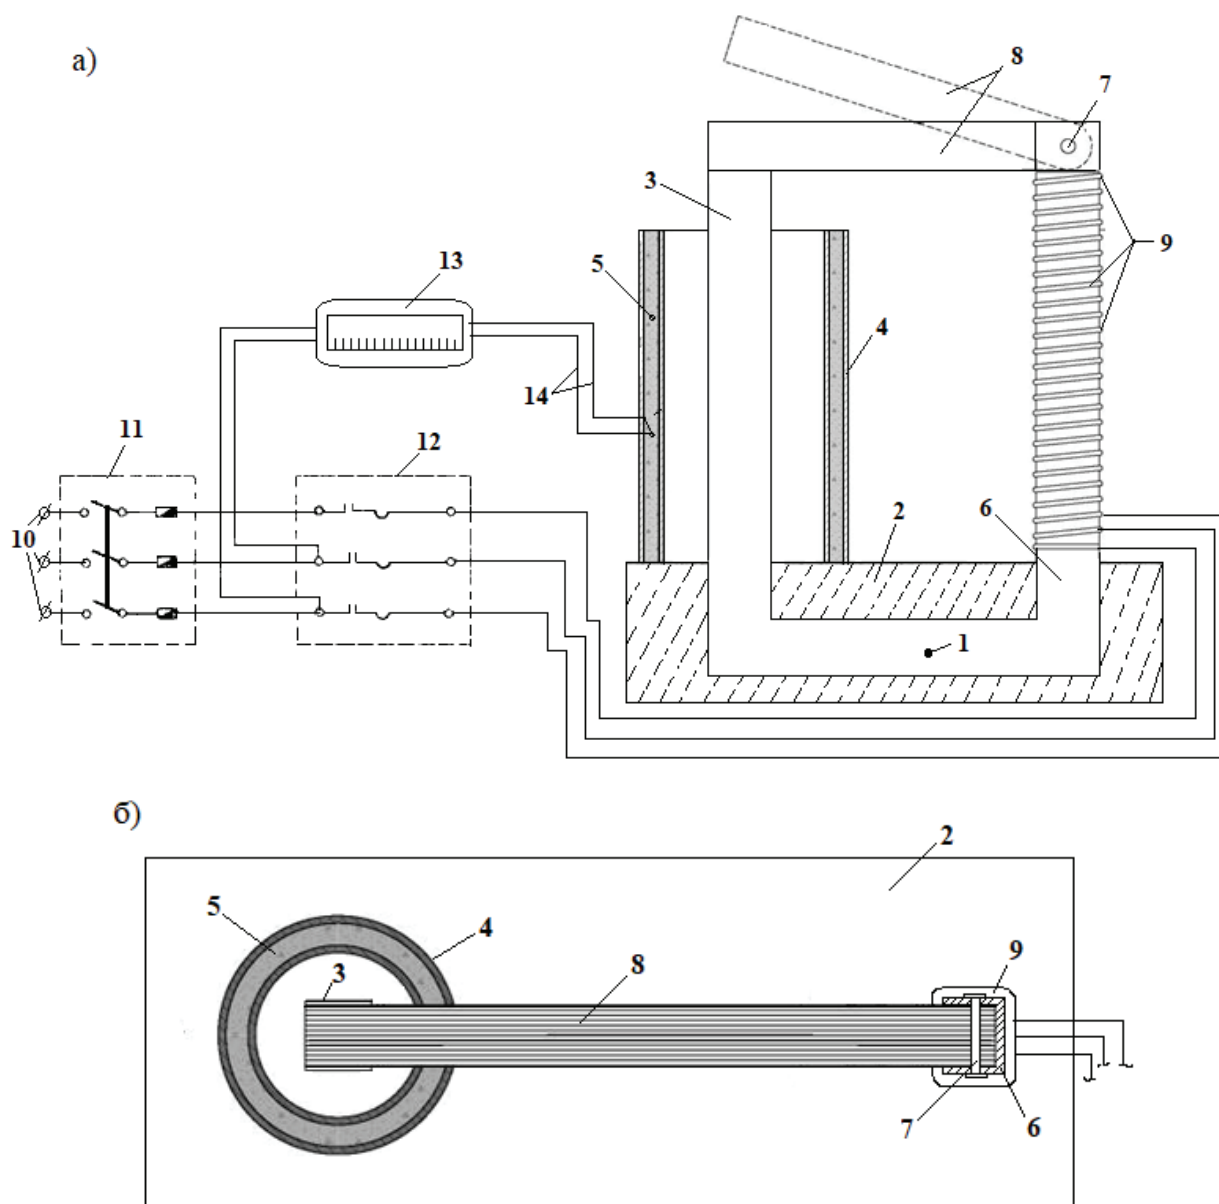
а) продольный разрез установки для тепловой обработки пустотелых железобетонных изделий; б) вид сверху установки: 1 – П-образный перевернутый вертикальный магнитопровод; 2 – фундамент; 3 – стержень; 4 – утепленная стальная (ферромагнитная) опалубка для пустотелых бетонных и железобетонных изделий; 5 – свежележенный бетон; 6 – вертикальный стержень; 7 – шарнир; 8 – магнитопроводный якорь; 9 – обмотка из изолированного кабеля (соленоид); 9 – источник переменного тока; 11 – рубильник; 12 – магнитный пускатель; 13 – автоматический потенциометр; 14 – термопара
